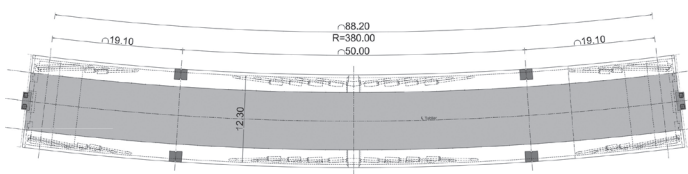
Pont Ain Houalla e Pont de la Tour Mohammed VI: Plantas dos tabuleiros. Pont Ain Houalla and Pont de la Tour Mohammed VI: Decks Plan View.
